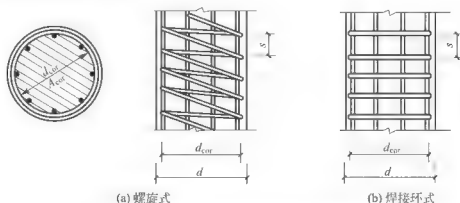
配螺旋式和焊接环式间接钢筋截面
